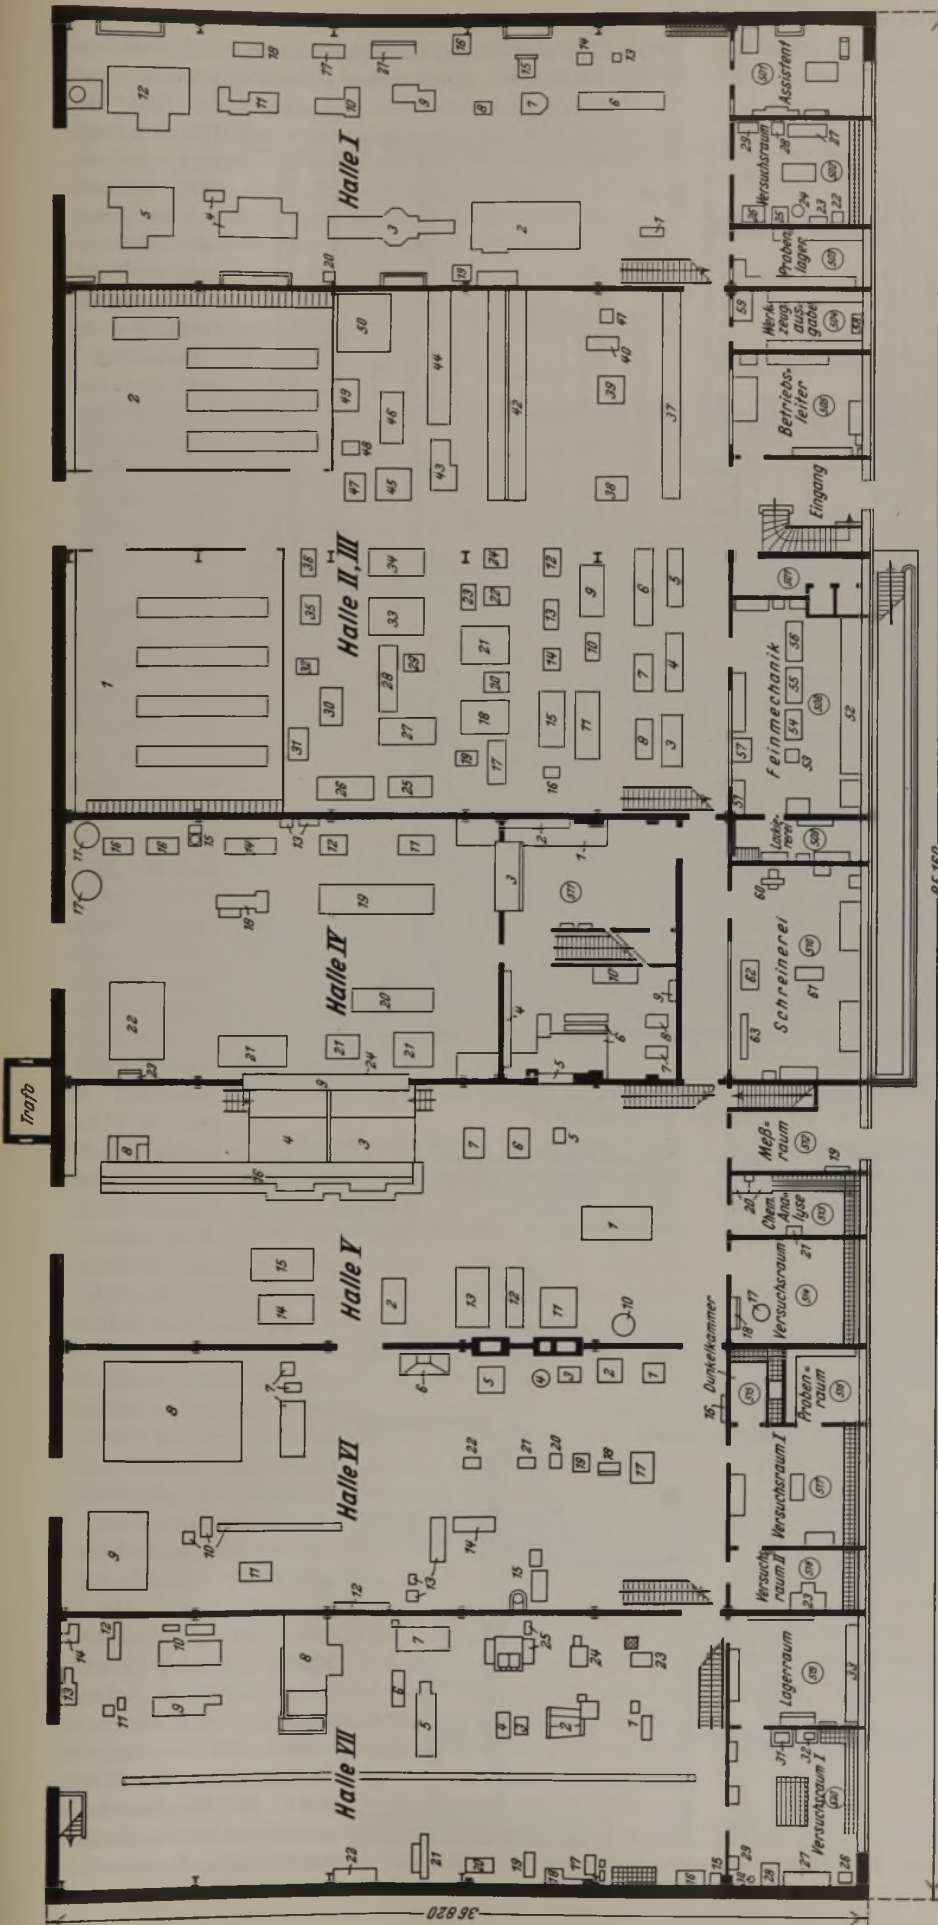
Erdgeschoss und Lehrschau (Grundriß).
